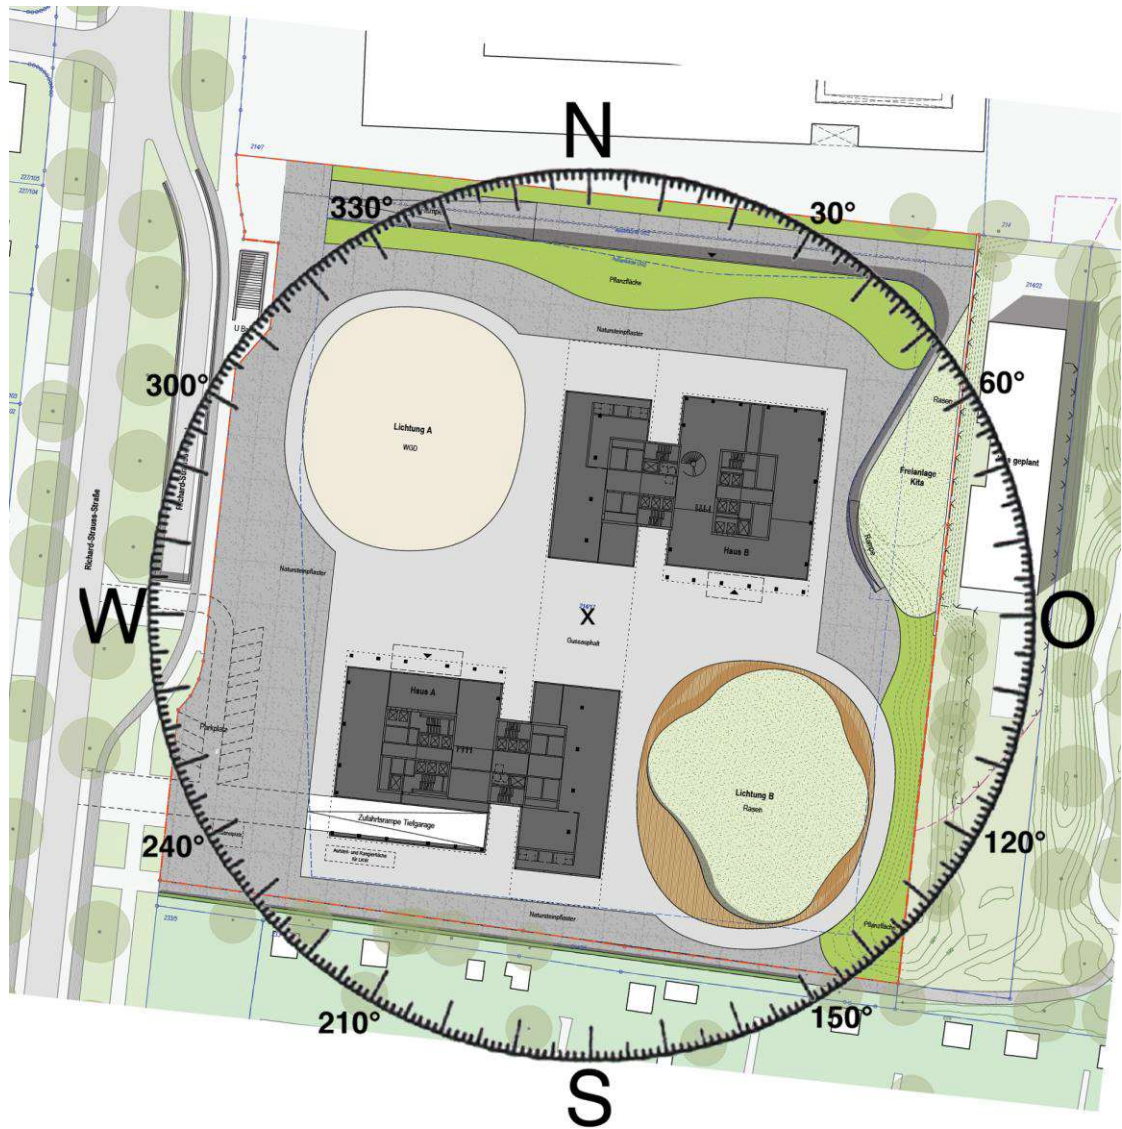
Lageplan der Hochhäuser RS76 mit Windrichtungsskala
